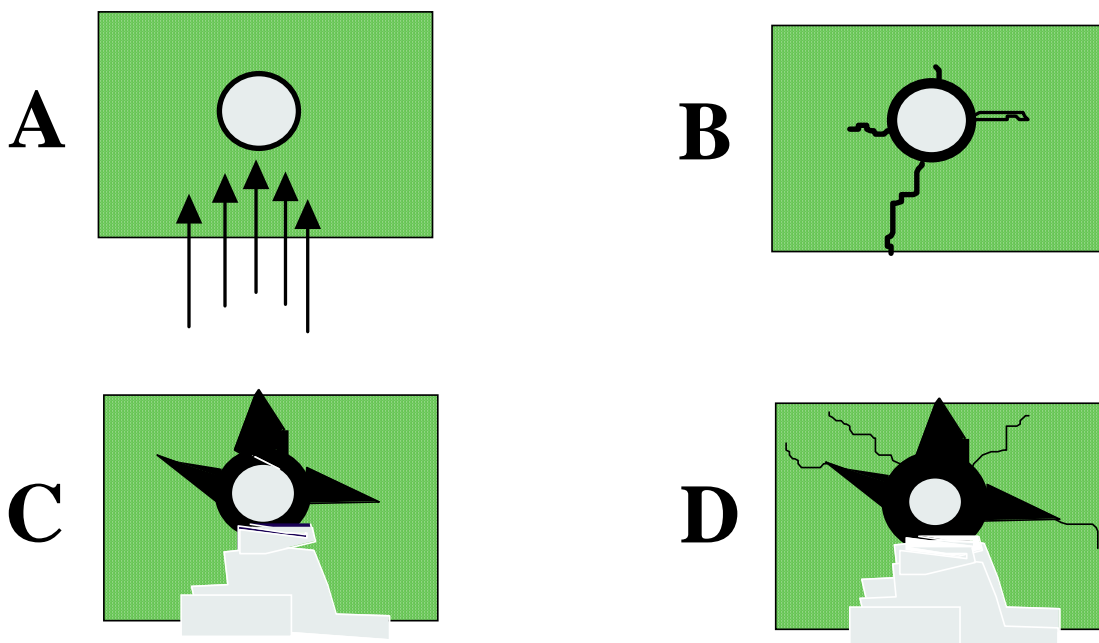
Representação gráfica da evolução da deterioração, ou envelhecimento das estruturas de concreto devido à corrosão das armaduras.
